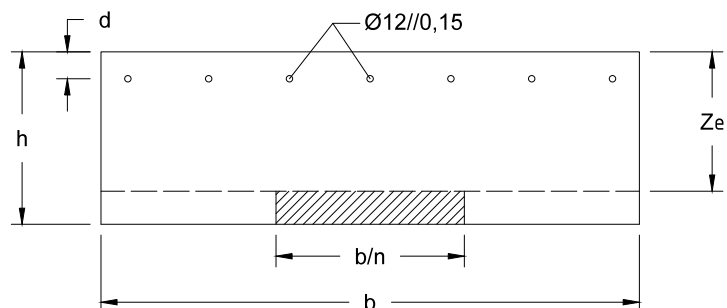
Elemento 2 – Elemento de laje fissurada à flexão da solução B
